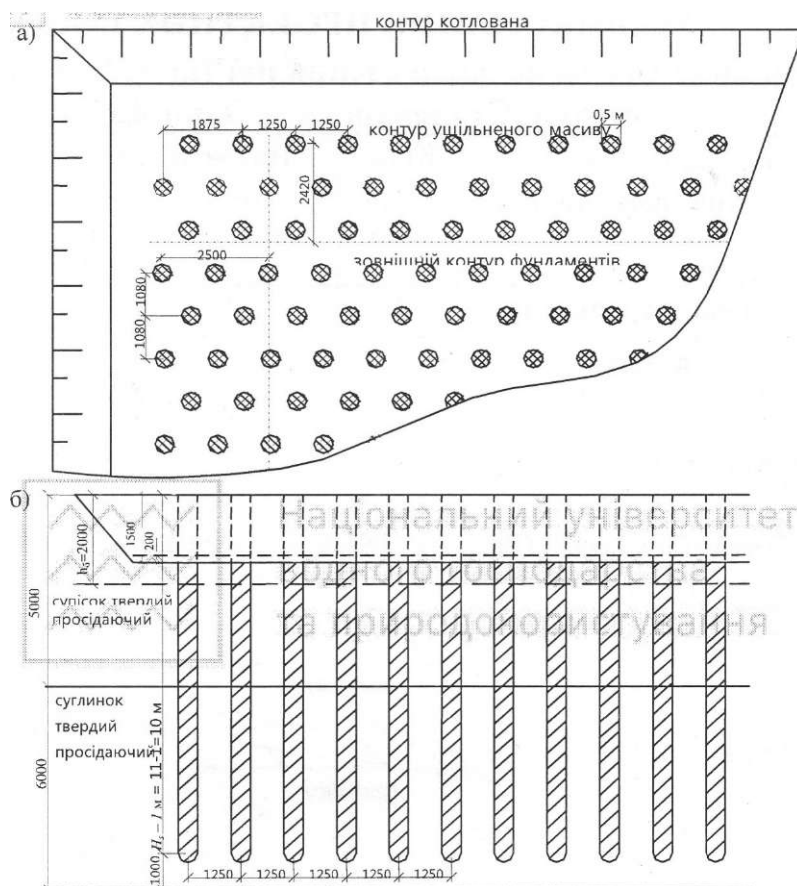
Технологічна карта виконання робіт з ущільнення ґрунтів ґрунтовими палями а - фрагмент плану ґрунтових паль; б - розріз ущільненого масиву і котловану
